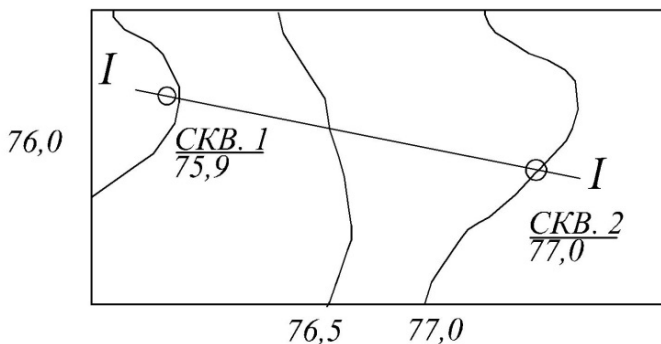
Схема расположения выработок грунта (план) на строительной площадке (пример 2.3)
